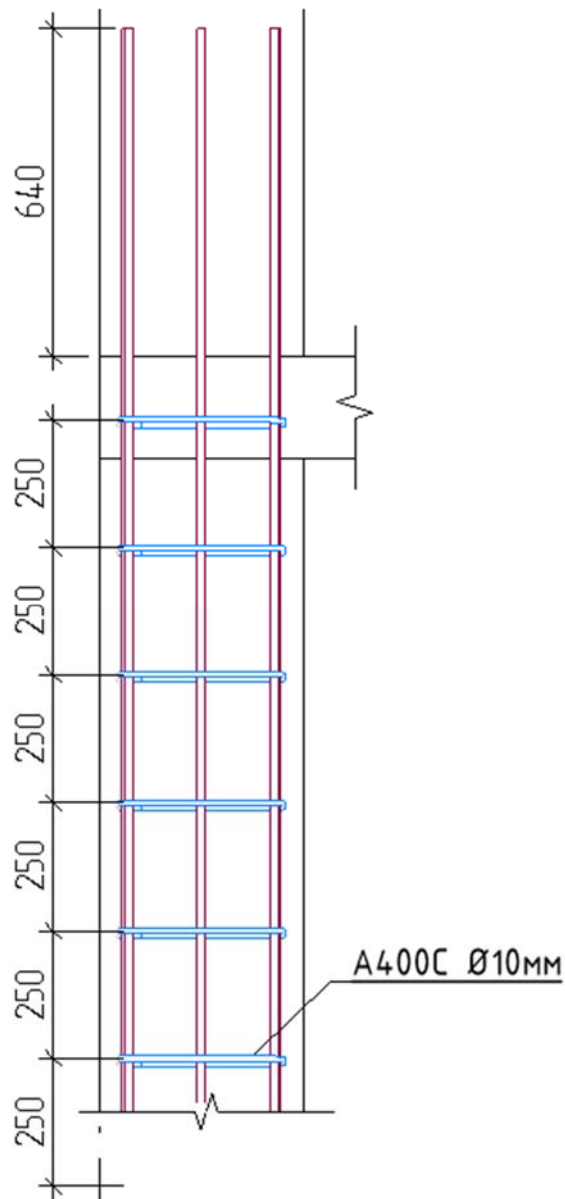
Схема розміщення поперечної арматури в тілі залізобетонної колони
